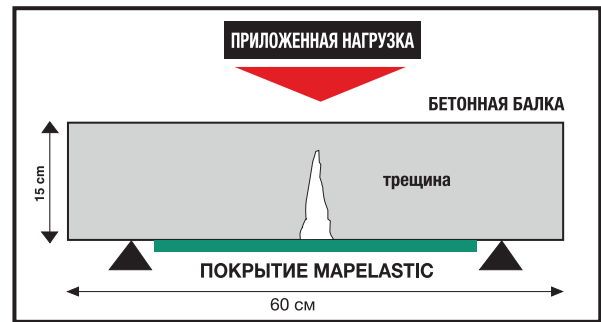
Защита трещины с помощью Mapelastic на нижней грани бетонной балки, подверженной изгибающей нагрузке
